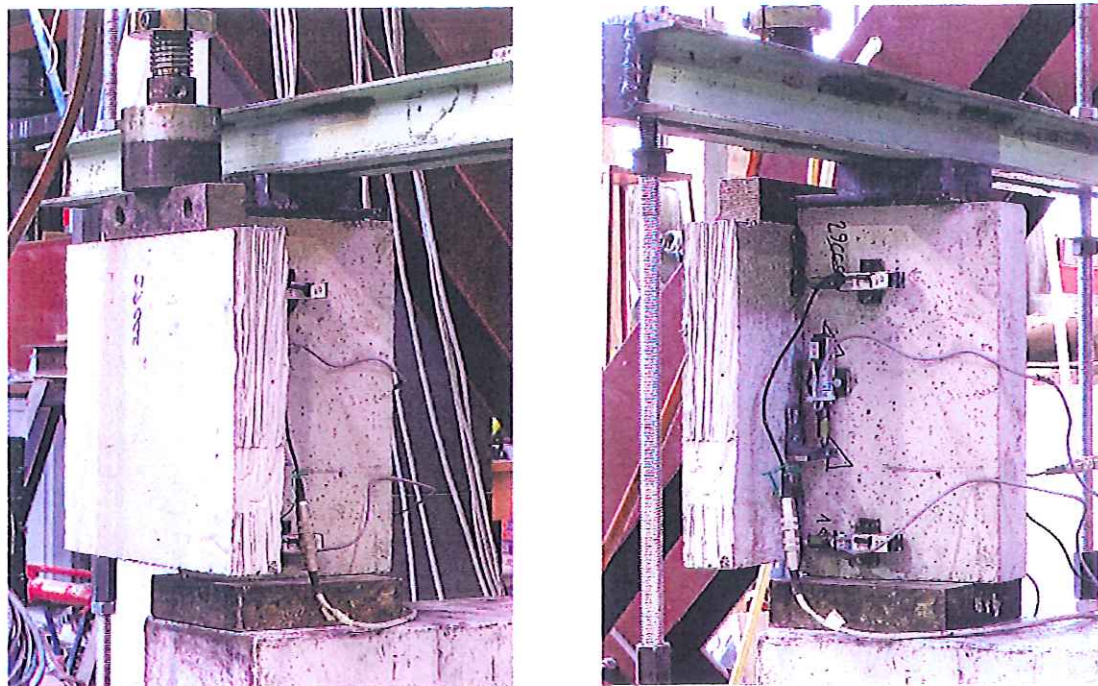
CS Concrete campione 28 - dettaglio della giunzione al termine della prova.-
